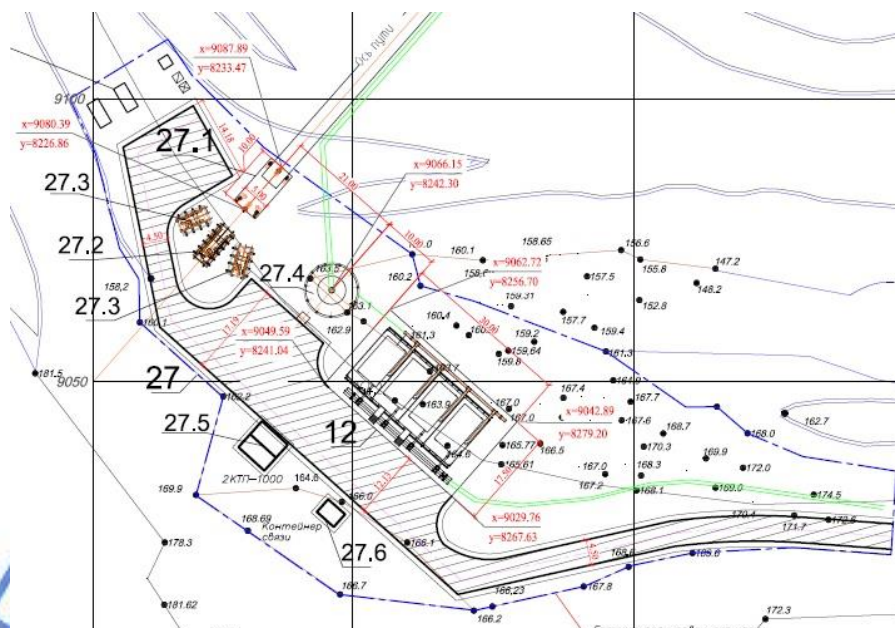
Схема генплана технологической площадки на уступе борта карьера +167 м.
